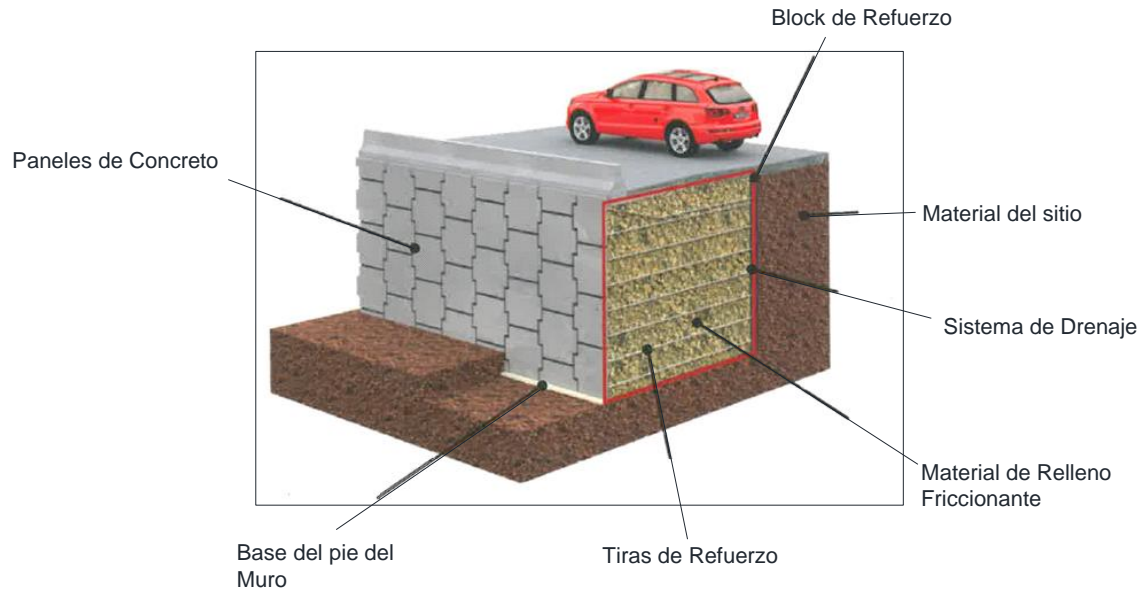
Elementos principales de un Muro de Tierra Armada
